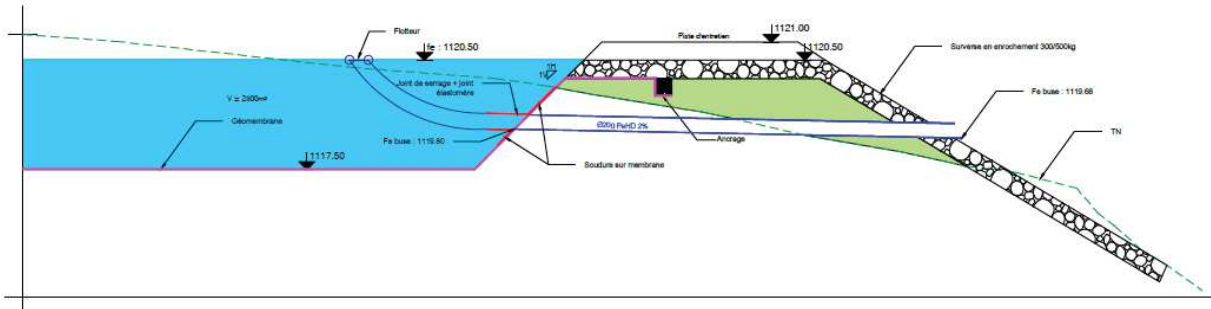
Coupe type du bassin de décantation du site (ALTI, juin 2021)
